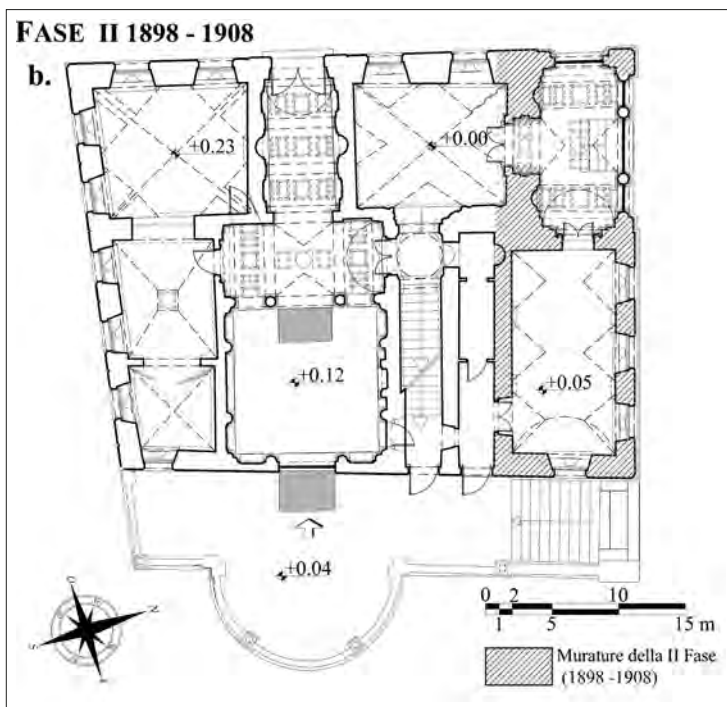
Palazzo Regis. Restituzione sul rilievo dello stato attuale della pianta del piano terra, con le murature della seconda fase di modifica (1898-1908) (da BENVENUTI 2016, fig. 12).
